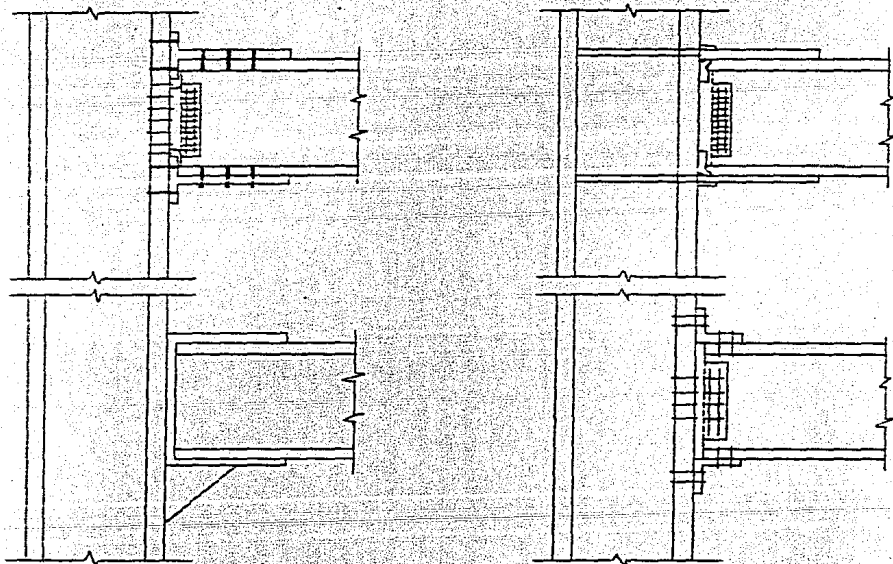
DETALLES DE CONEXION VIGA-COLUMNA
